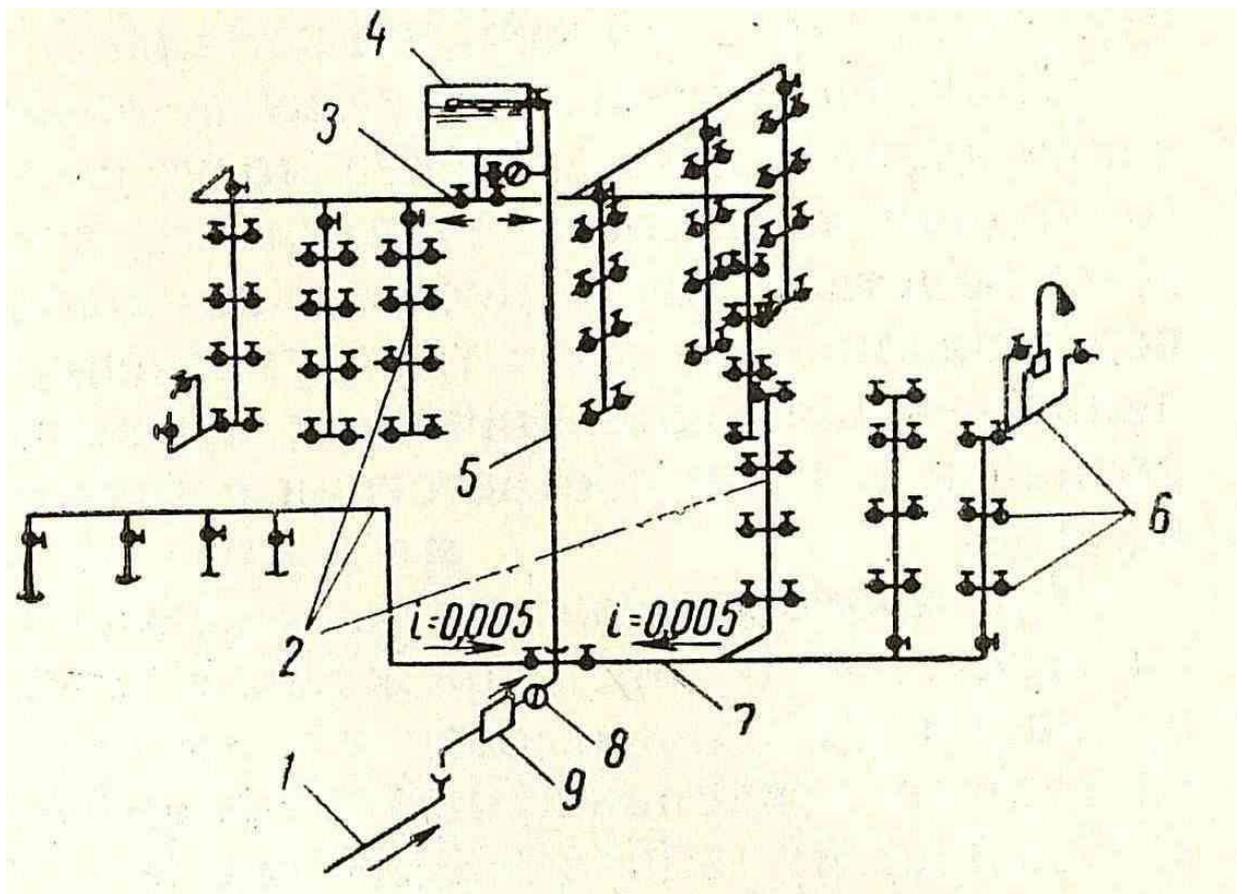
Система водоснабжения здания с баком без повысительной насосной установки:
